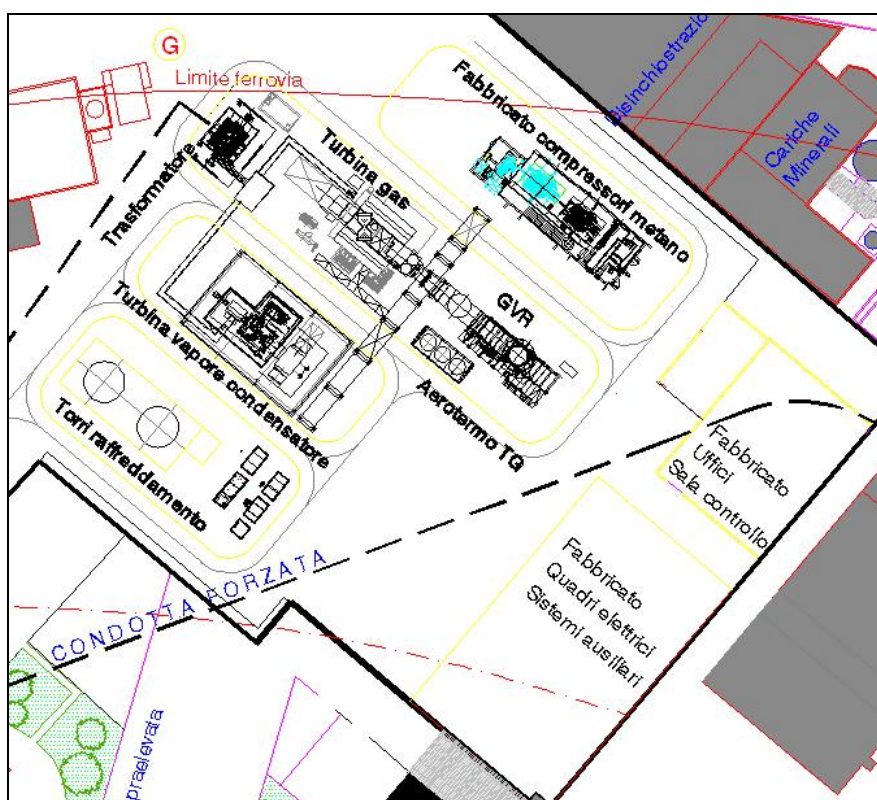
Estratto Lay-out della Centrale nel sito esistente
